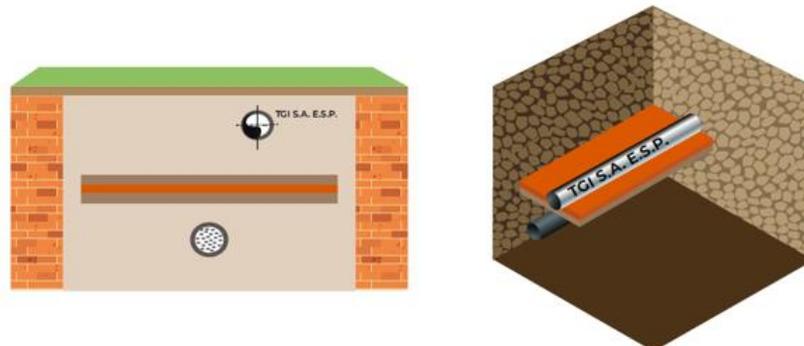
Protección con ladrillos más planchas de caucho sintético o placas de PRFV-parallelismo.
